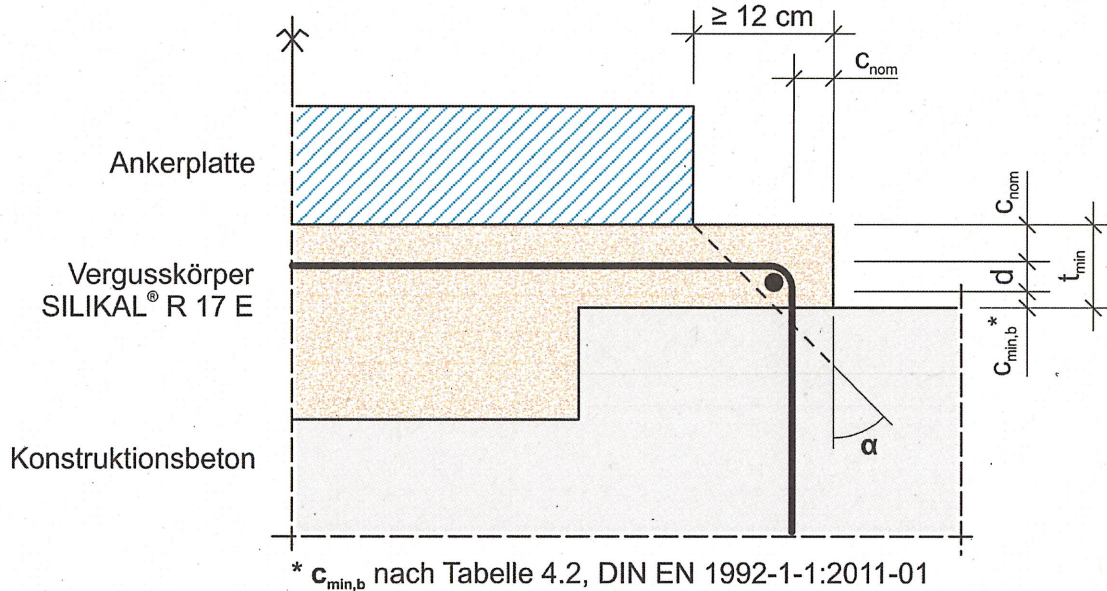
Randabstände, Betondeckung und Lastausbreitung
